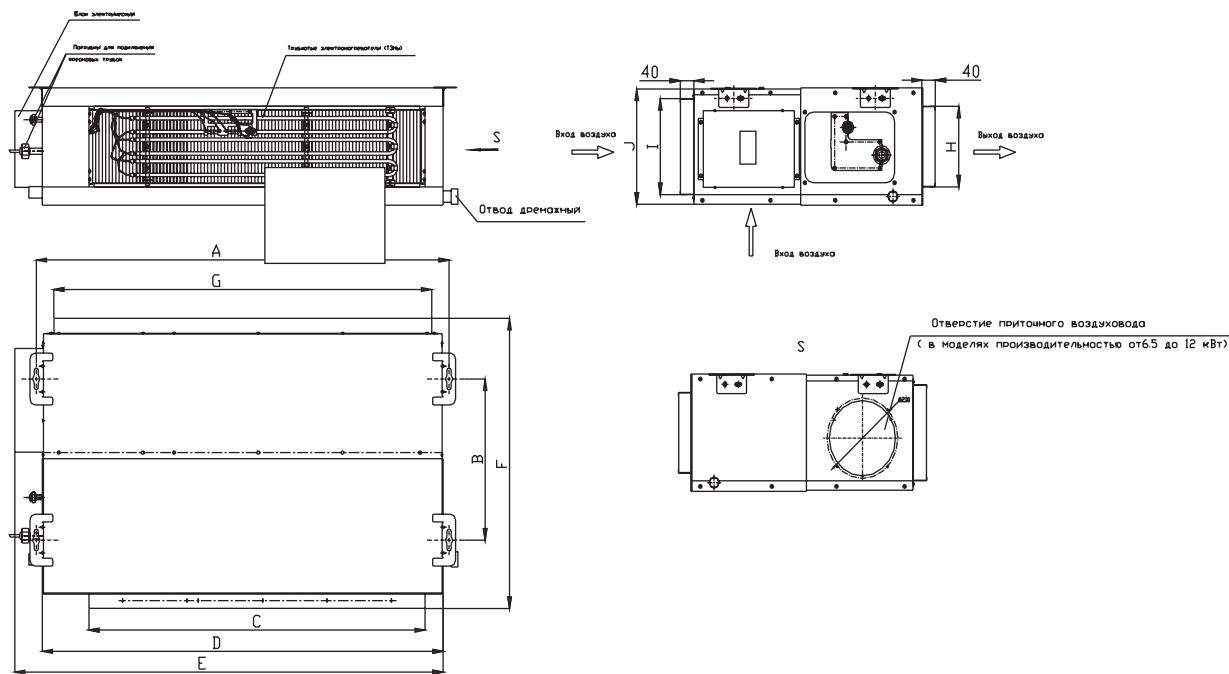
Габаритные и установочные размеры блока кассетного типа
